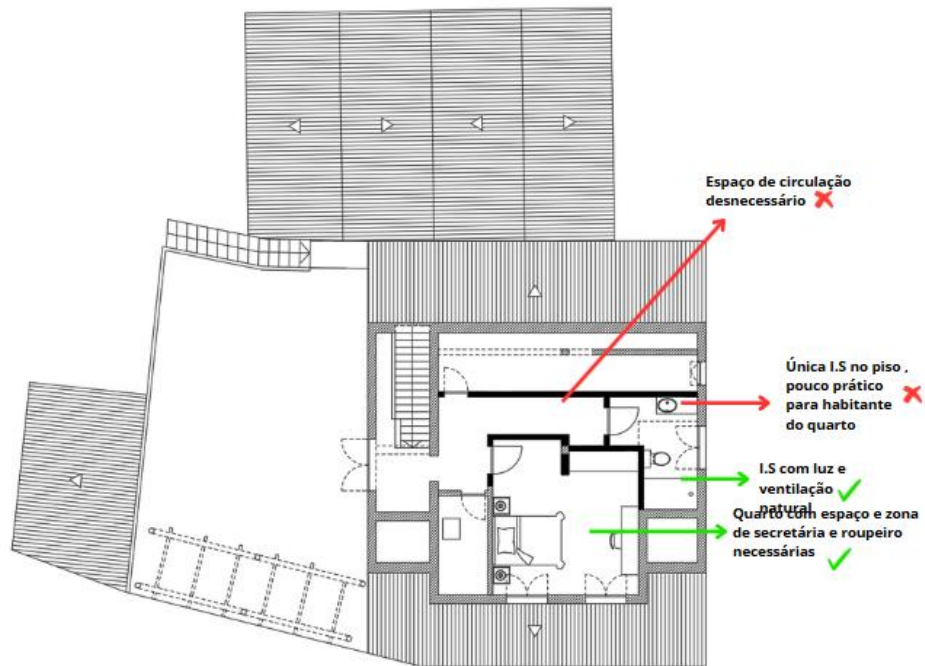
Análise de plantas esboço, proposta 2, piso 1
